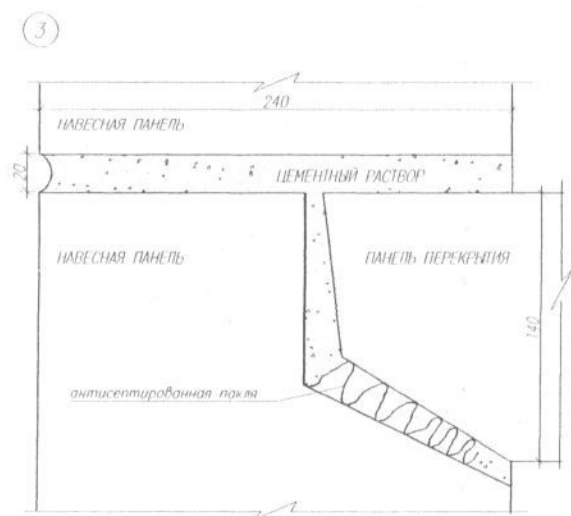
Стык перекрытия и навесных наружных панелей
